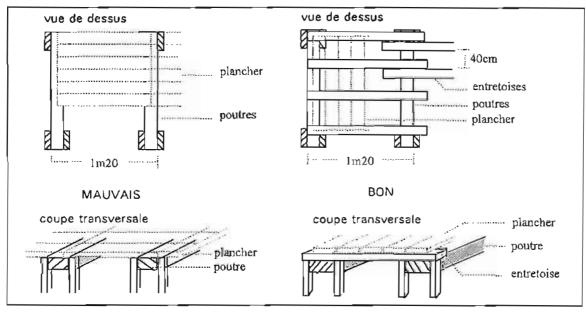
Planchers insonorisés (absorbant les vibrations causées par les déplacements) : principe de montage d'un plancher
